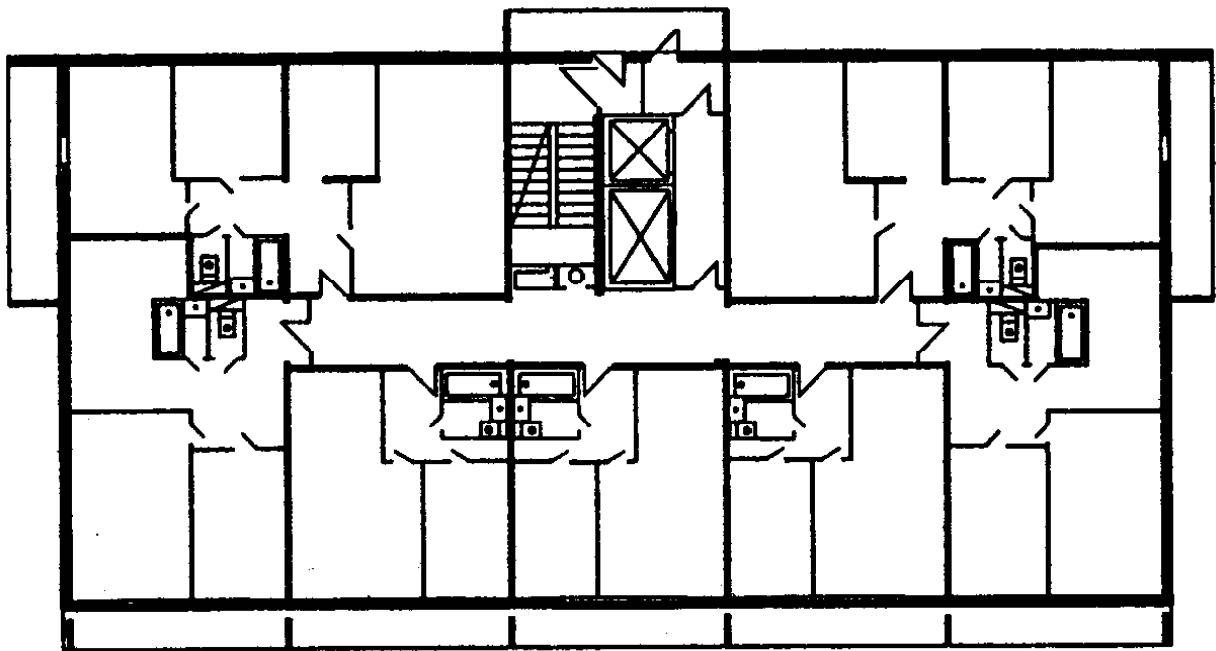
Секції в будинках дев'ятого виду забудови початку 70-х років із покращеним плануванням квартир, типовий поверх одnoseкційного панельного будинку серії П-68
